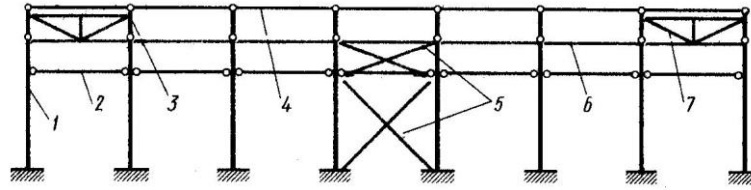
Продольная рама каркасного здания: 1 – колонна; 2 – подкрановая балка; 3 – балка покрытия; 4 – плита покрытия; 5 – вертикальные связи по колоннам; 6 – распорки; 7 – вертикальные связи покрытия
